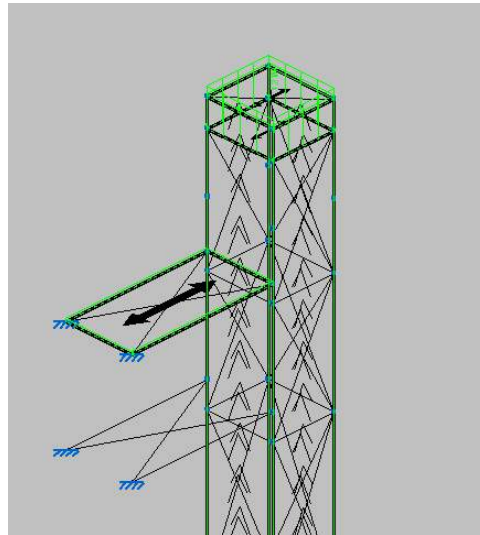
Representación distribución cargas en zona superior de la estructura.
